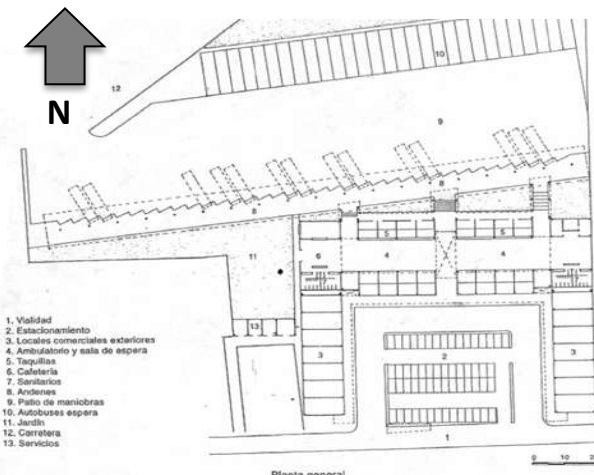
Planta Arquitectónica de la Central de Autobuses de Zacapu, Michoacán
